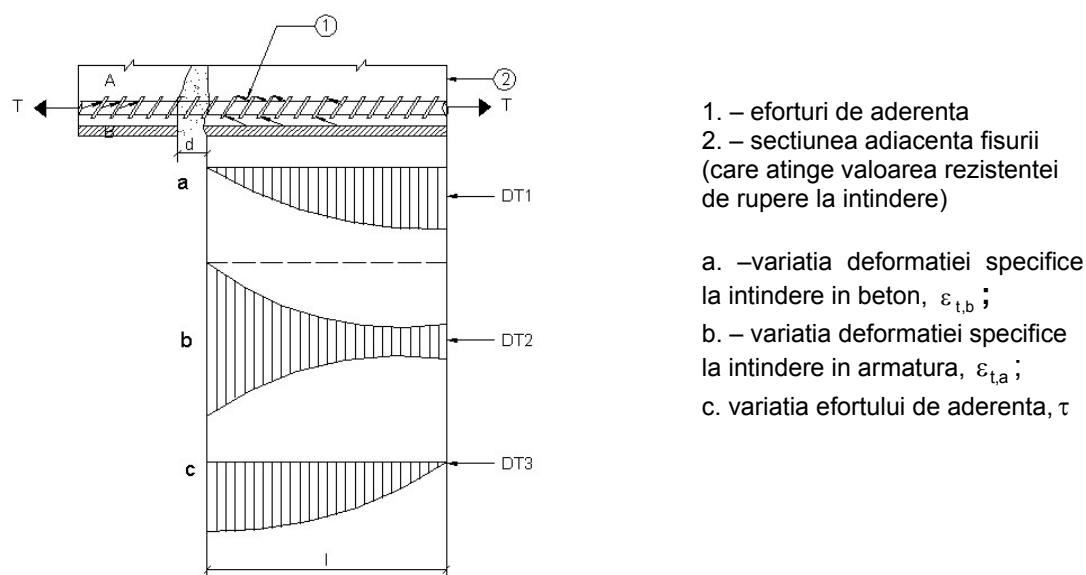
Mecanismul de fisurare a betonului
